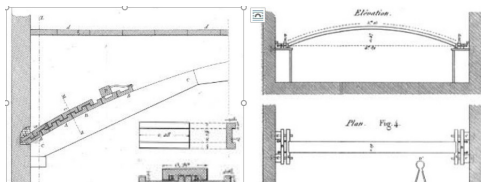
Trabalhos de d'Olivier: (a) tijolos com rebordo lateral: aplicação e pormenores; (b) ensaios em corte e planta e dinamómetro (Olivier 1837)
